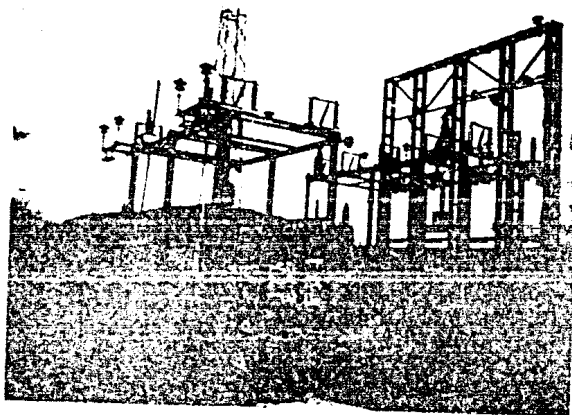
E.d. Vista parcial de un puesto de seccionamiento.
